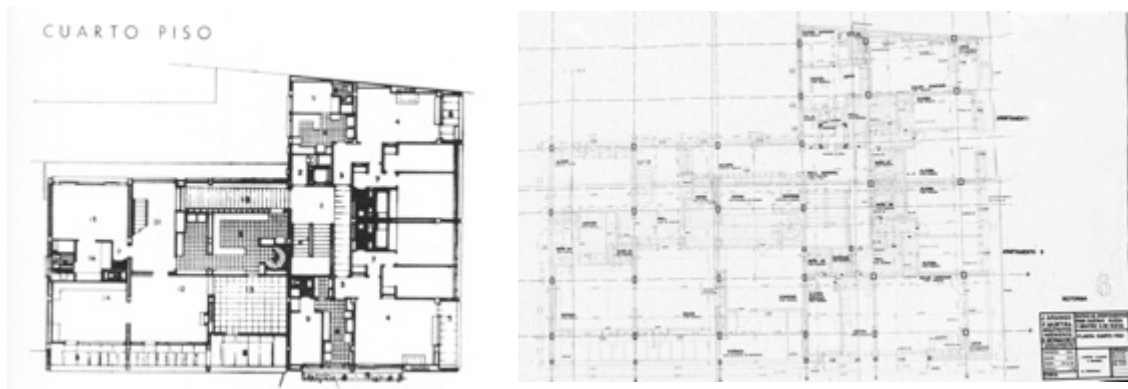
Cuarto Piso – Acceso apartamento del *Pent House
